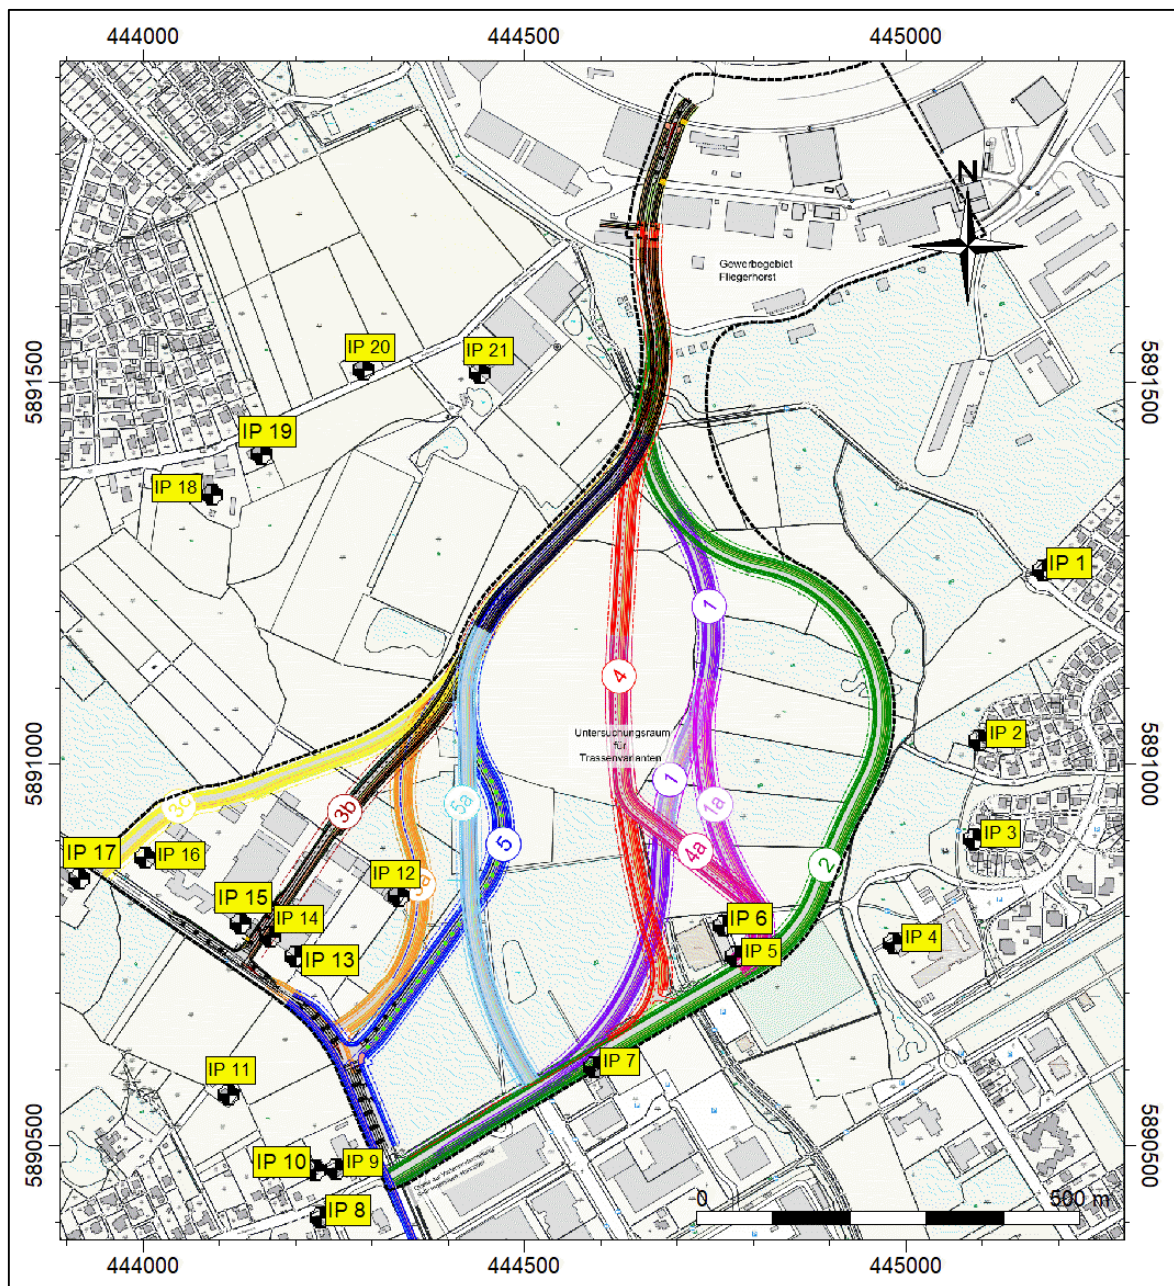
Lageplan der maßgeblichen Immissionsorte (hinterlegter Plan: Quelle [9]).
